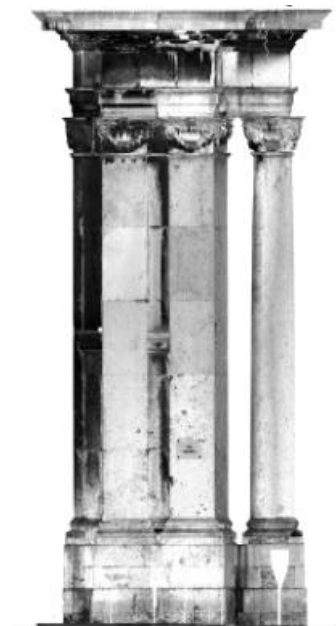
Levantamento 3D laser, Corte transversal CT1
